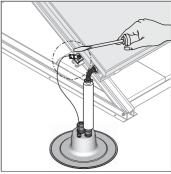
Fissare il morsetto di compensazione del potenziale
